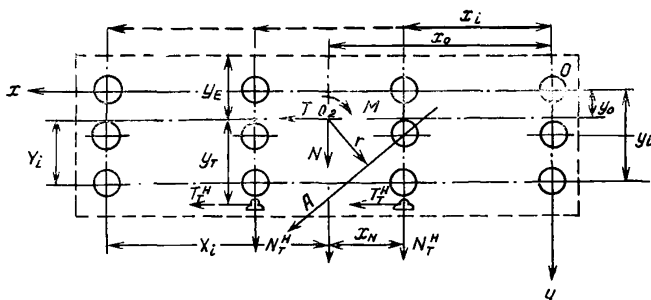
Схема к расчету горизонтальных нагрузок на опоры от вращения сечения. Контуры верхнего строения ростверка показаны пунктиром
